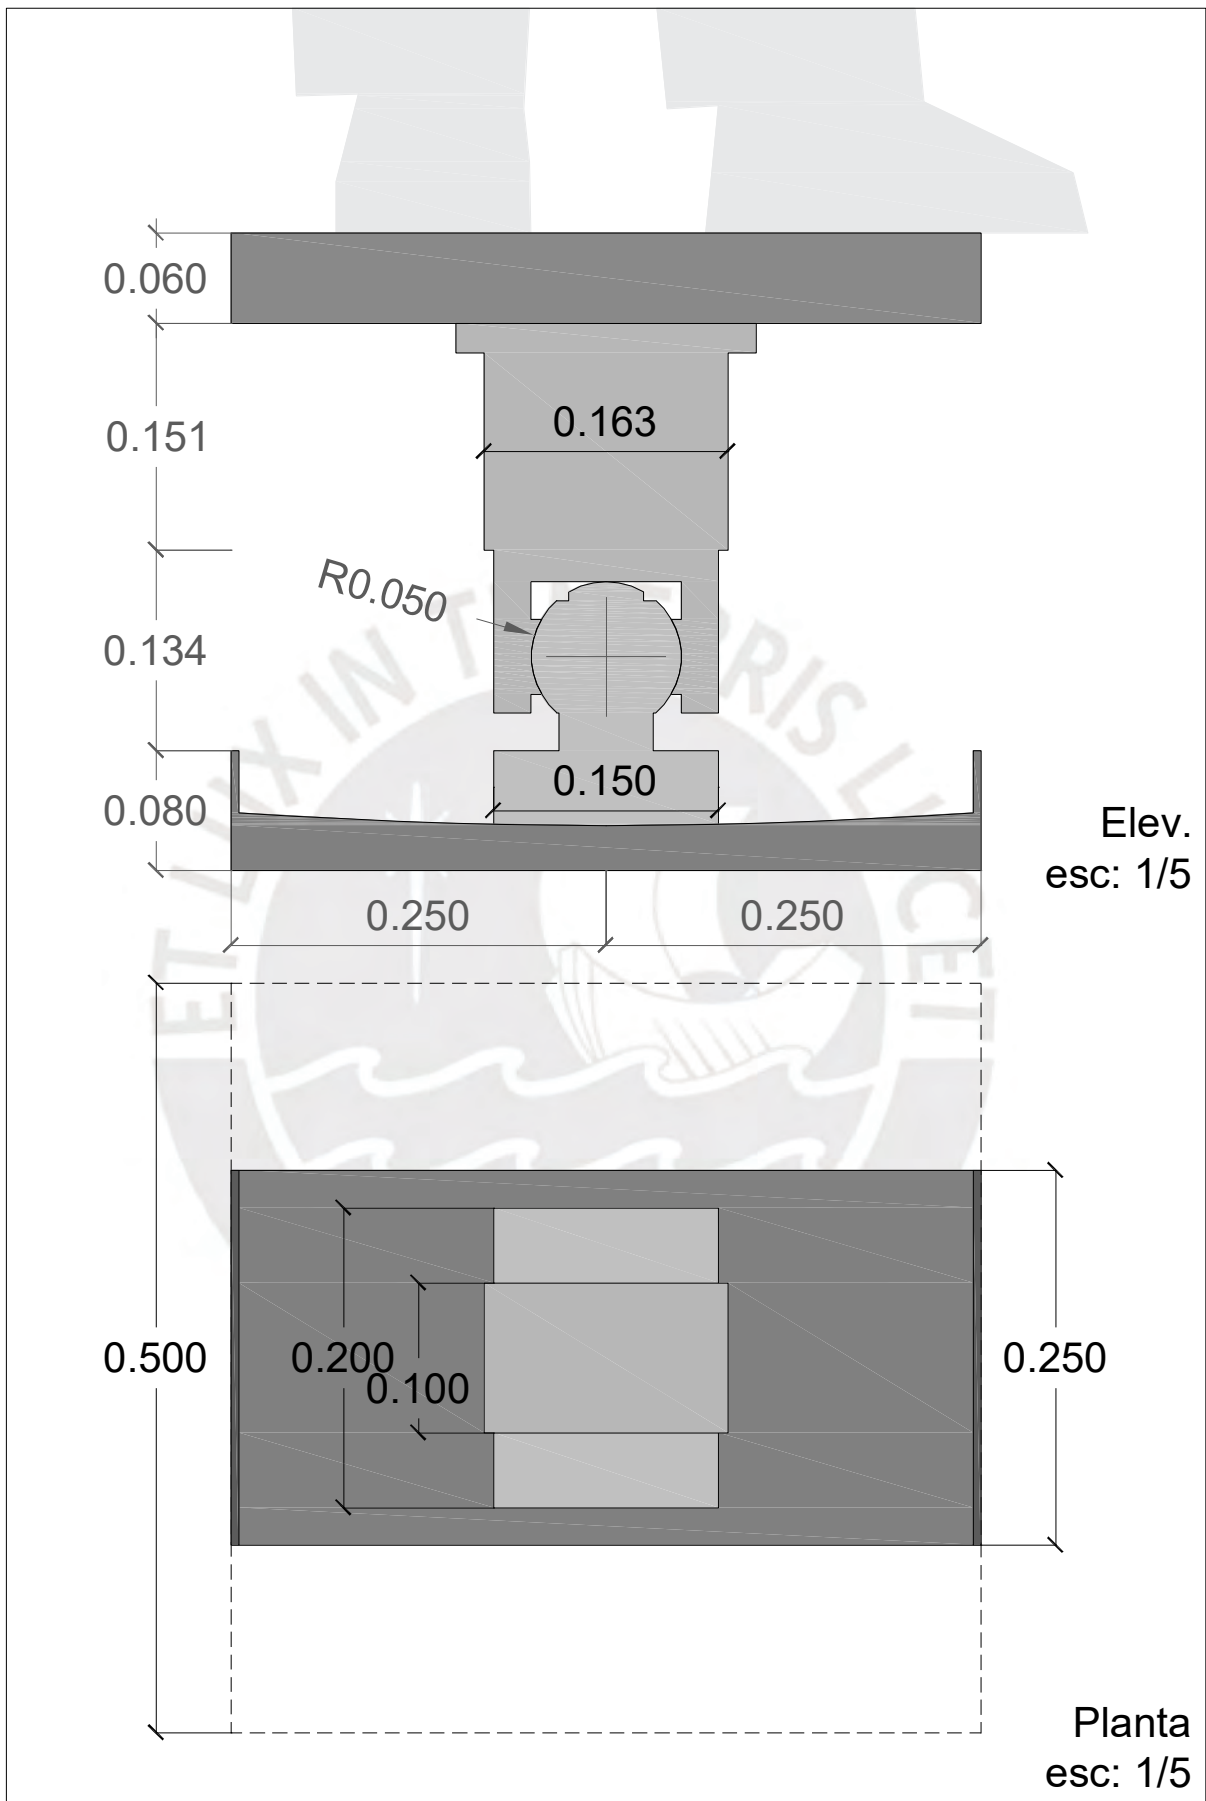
17: Elevación y planta del segundo modelo de sistema de aislamiento.
